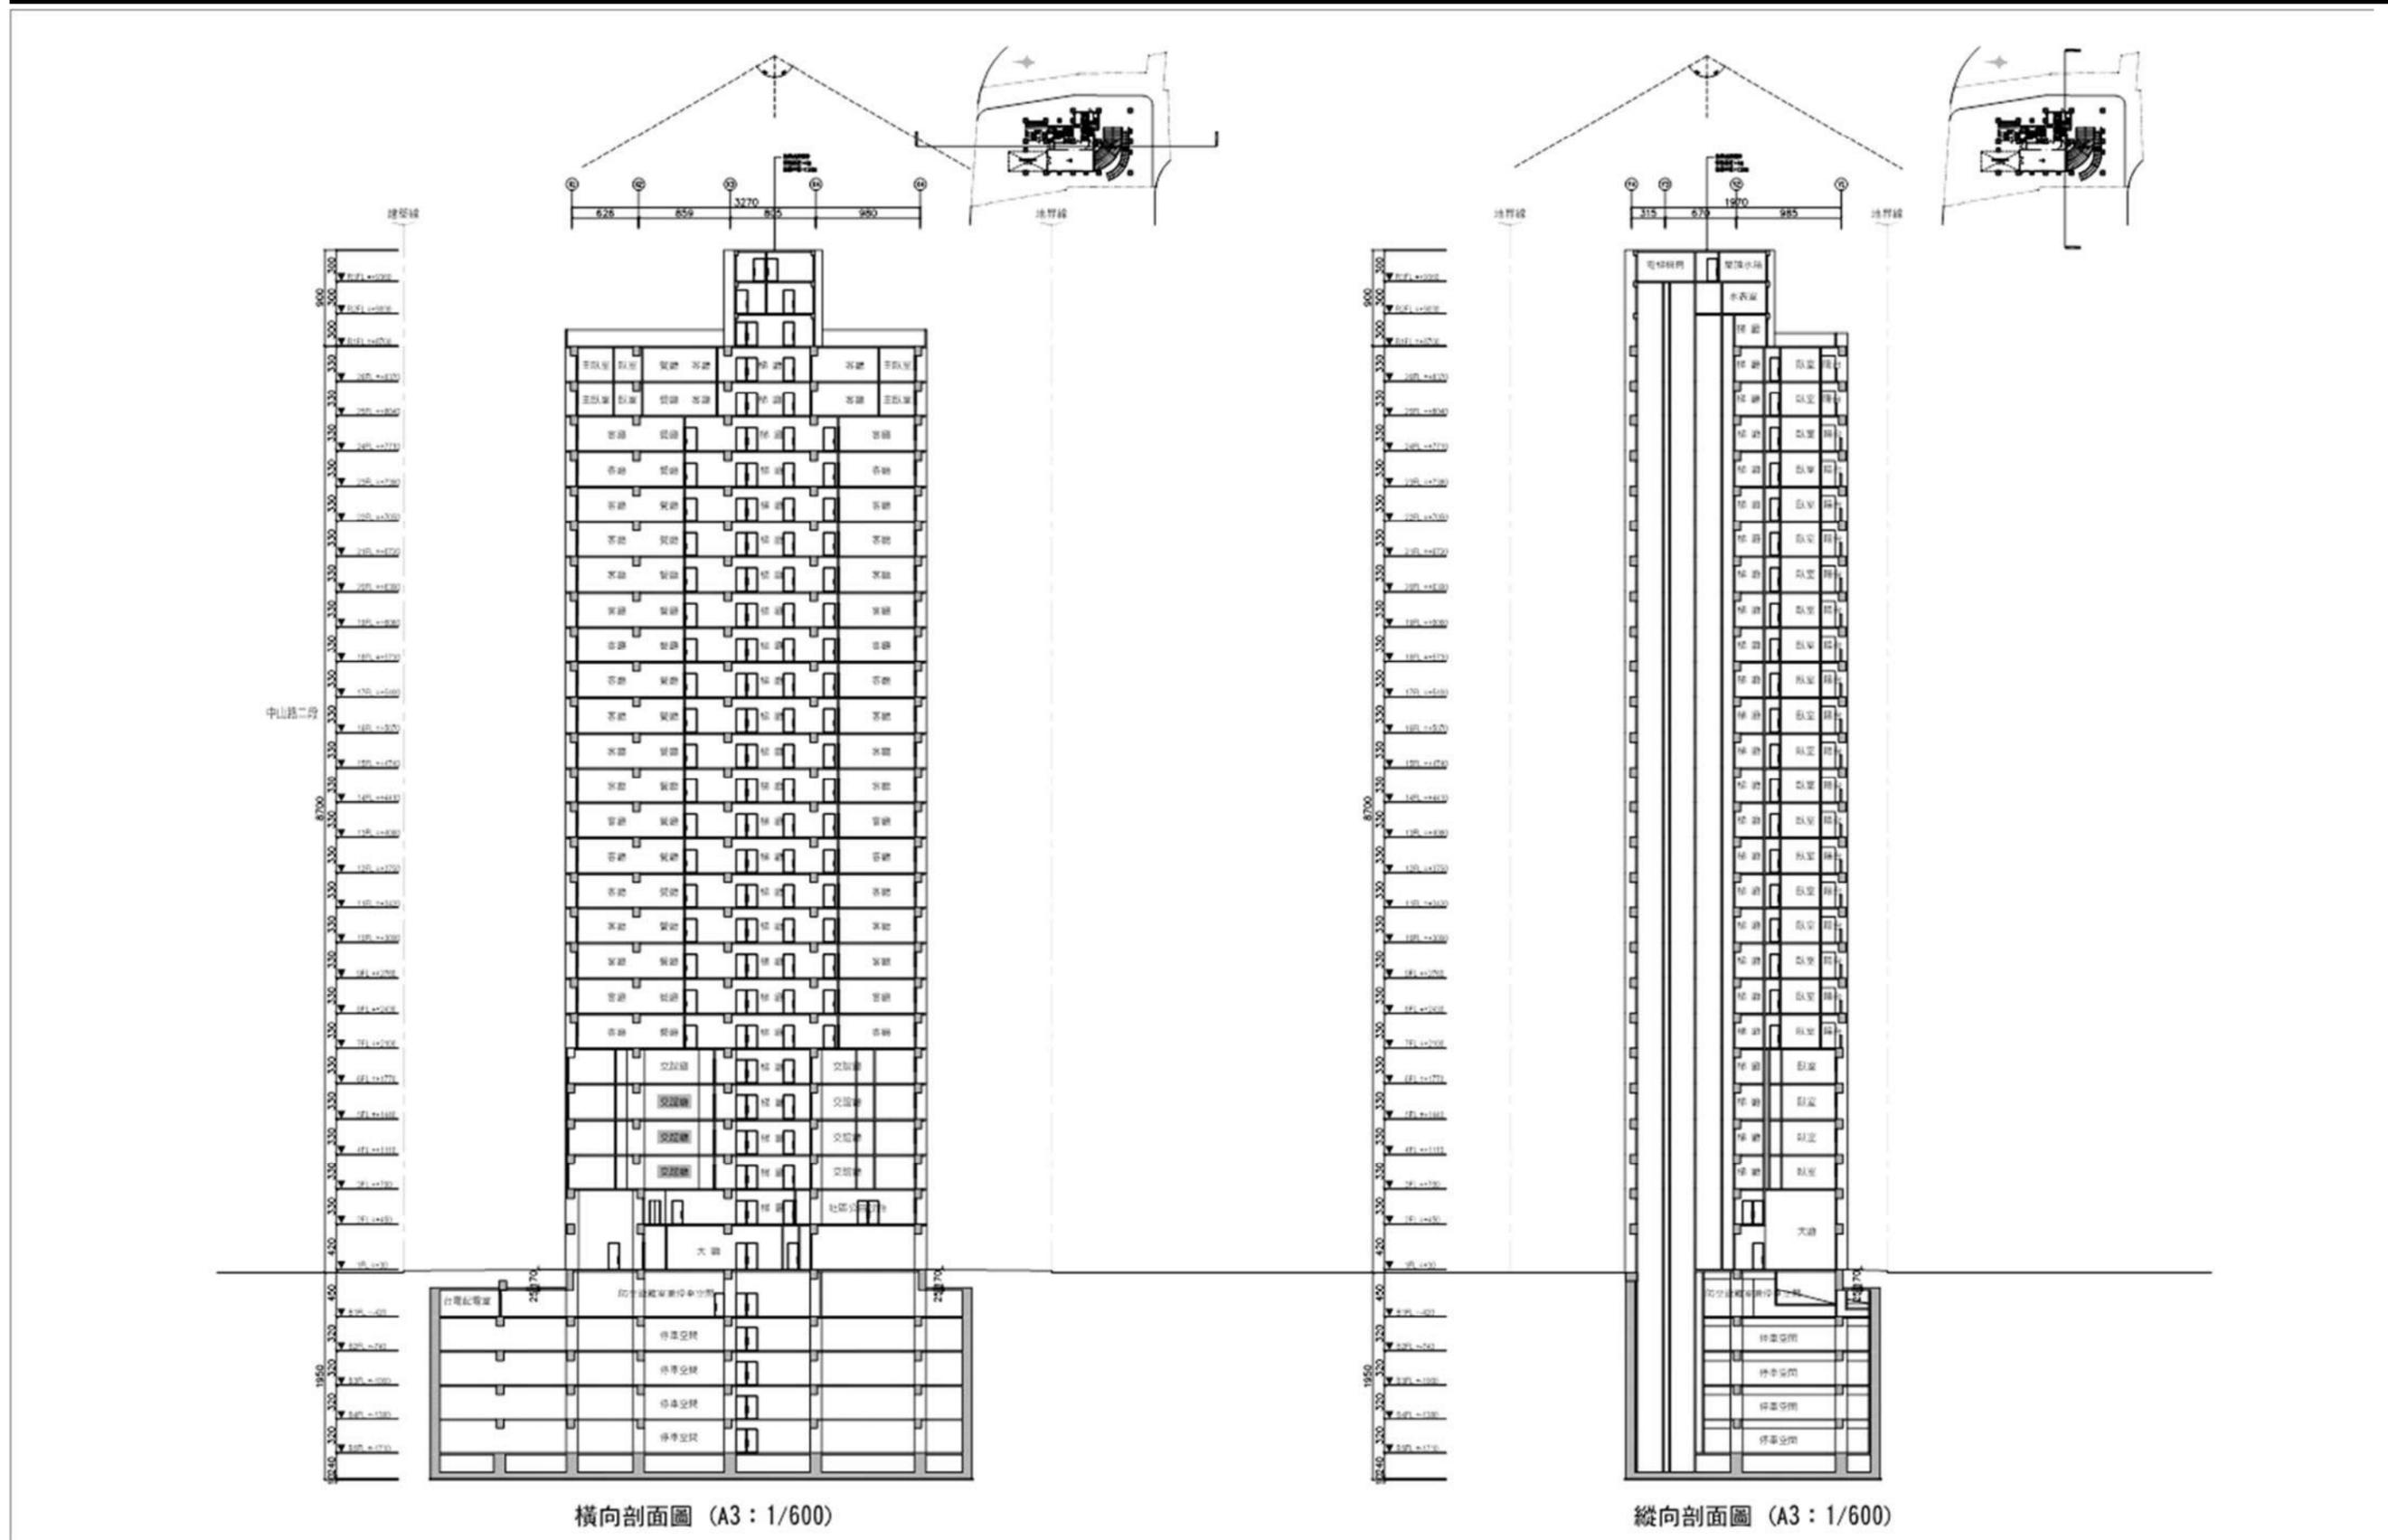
、縱向及橫向剖面圖 (S: 1/600)
